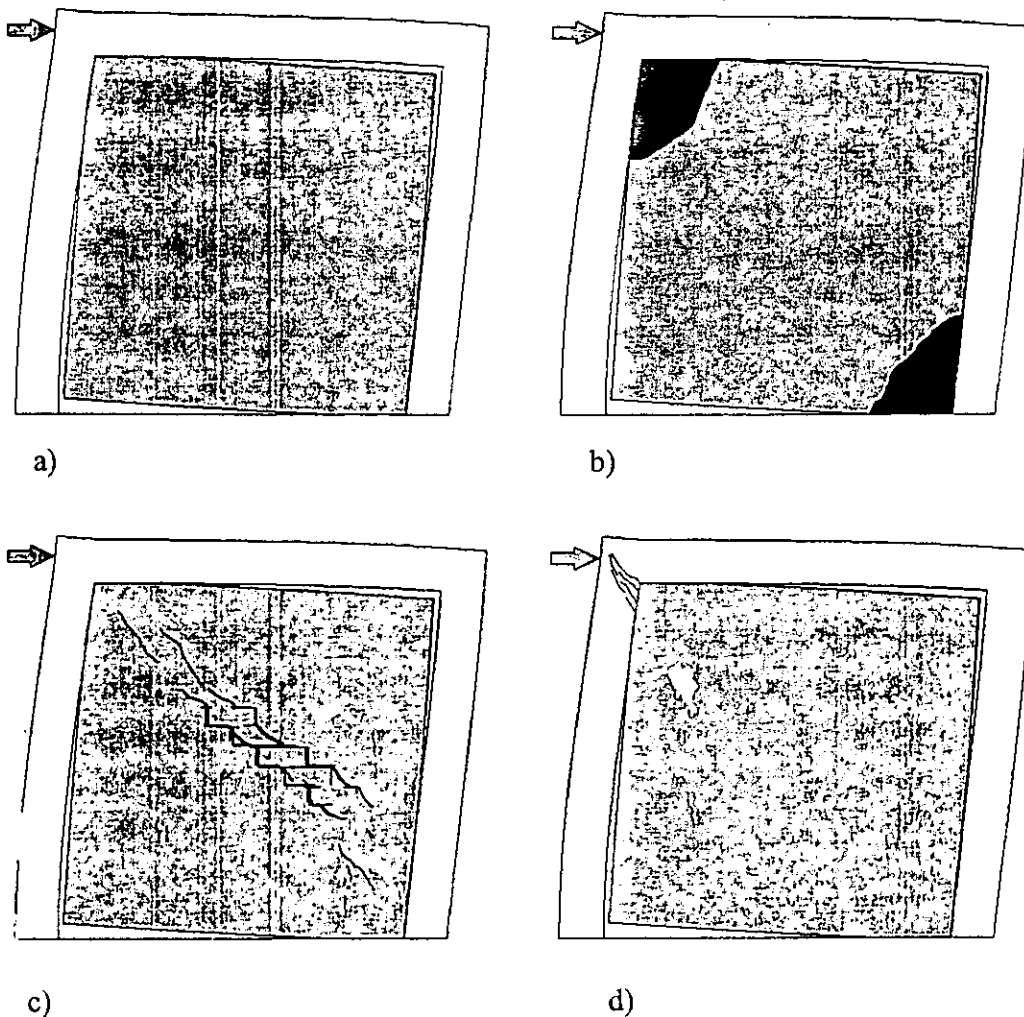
Modos de falla de marcos con muros de relleno de mampostería (Moghaddam y Dowling 1987); a) separación; b) aplastamiento de esquina; c) agrietamiento inclinado; d) falla de la columna en tensión.
